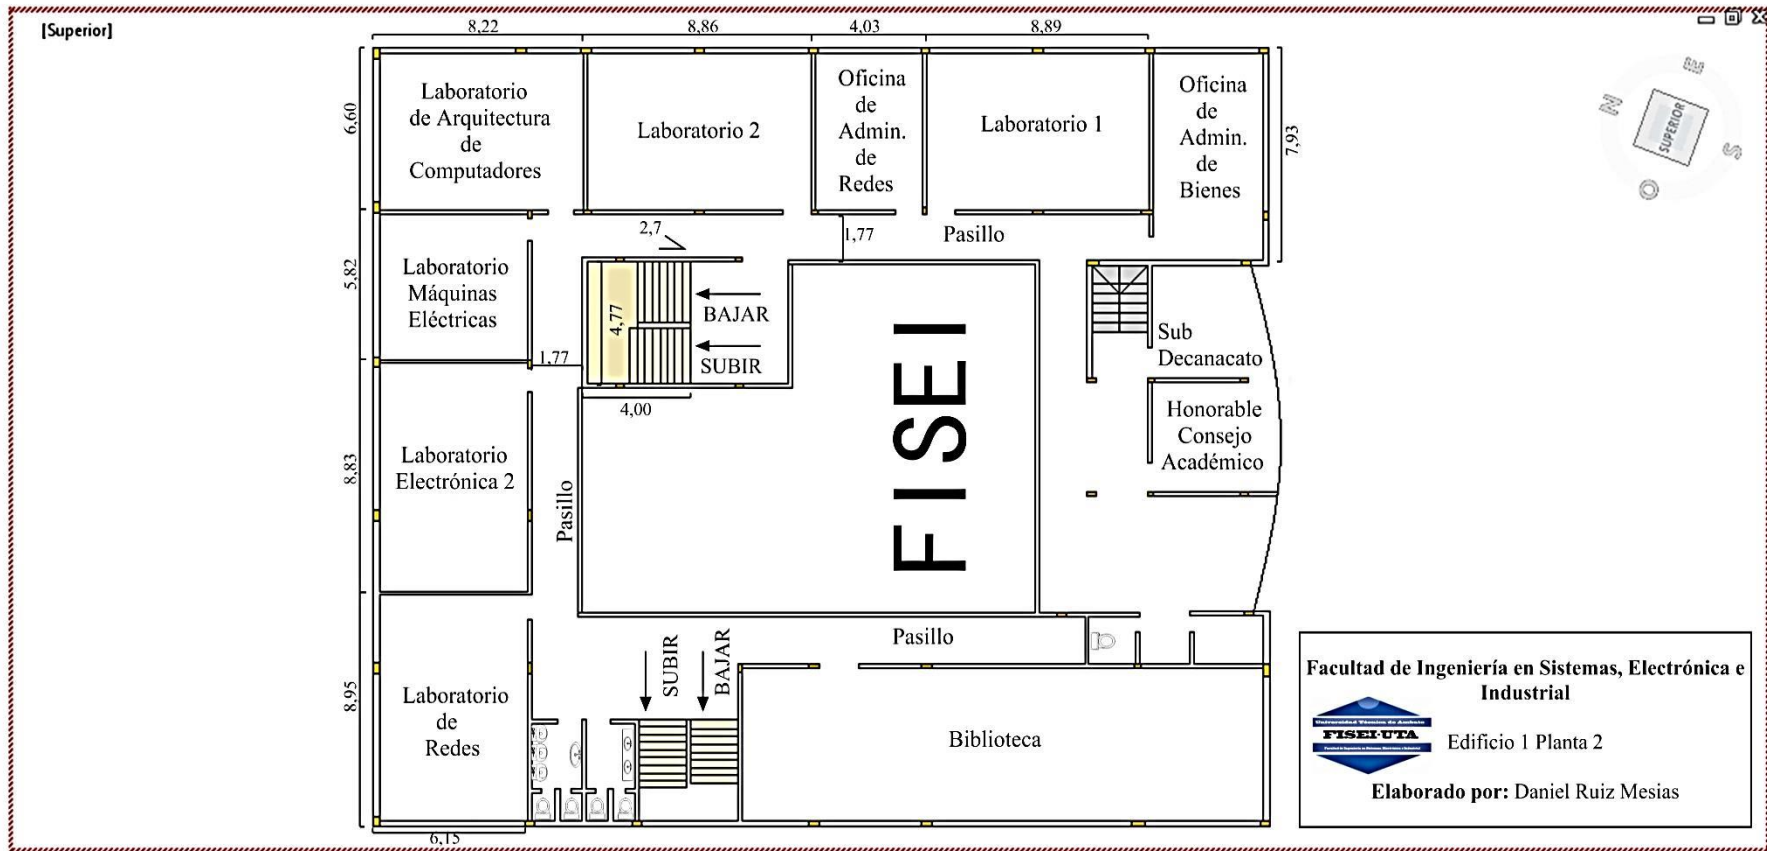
Planos de la segunda planta del edificio 1 de la FISEI –UTA.
